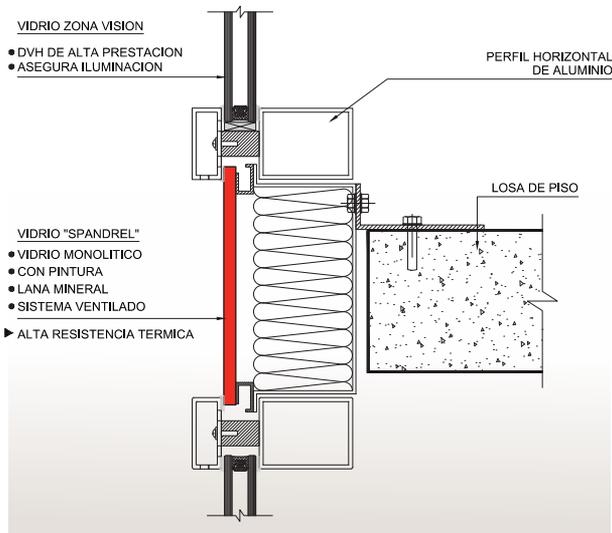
Muros cortina con vidrios de antepecho aislados térmicamente.
